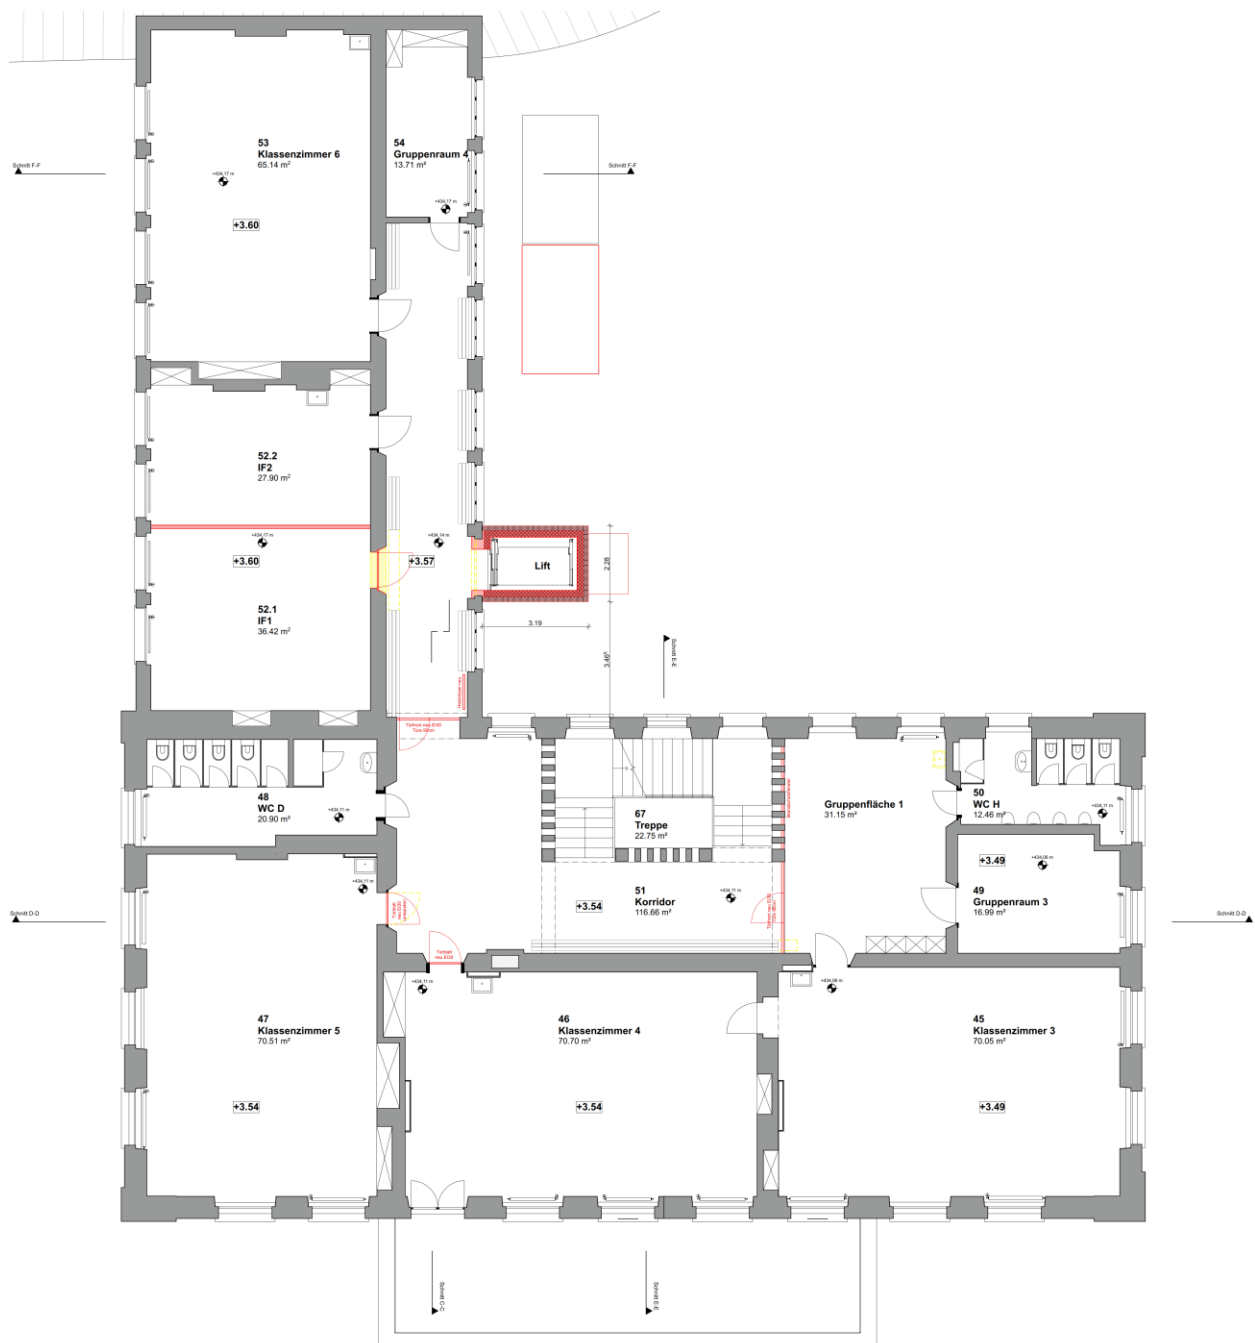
Grundrissplan 1. Obergeschoss
